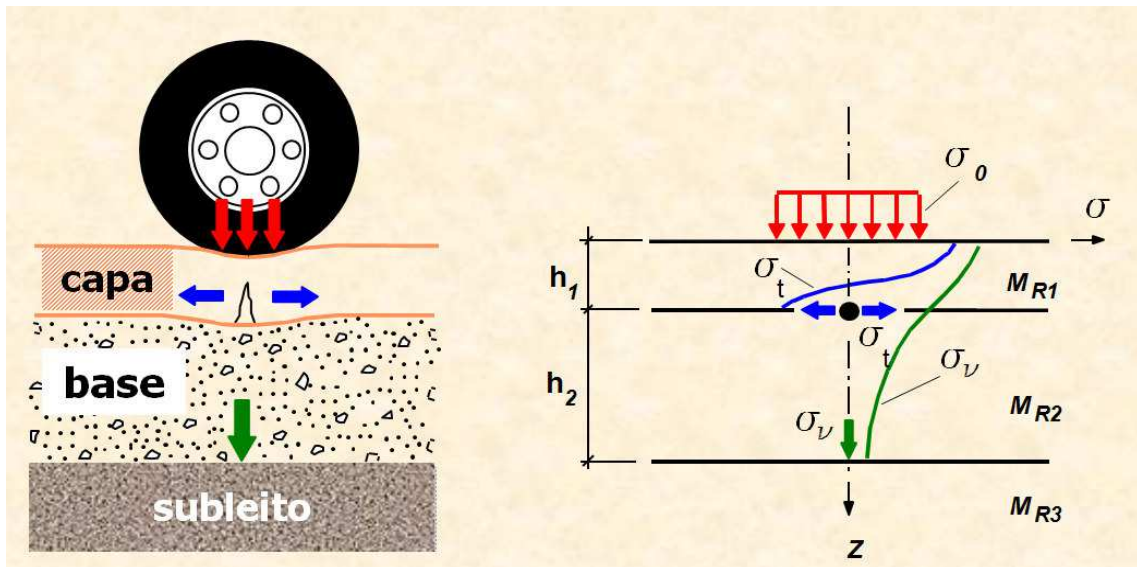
Tensões numa estrutura de pavimento (MEDINA e MOTTA, 2005)
